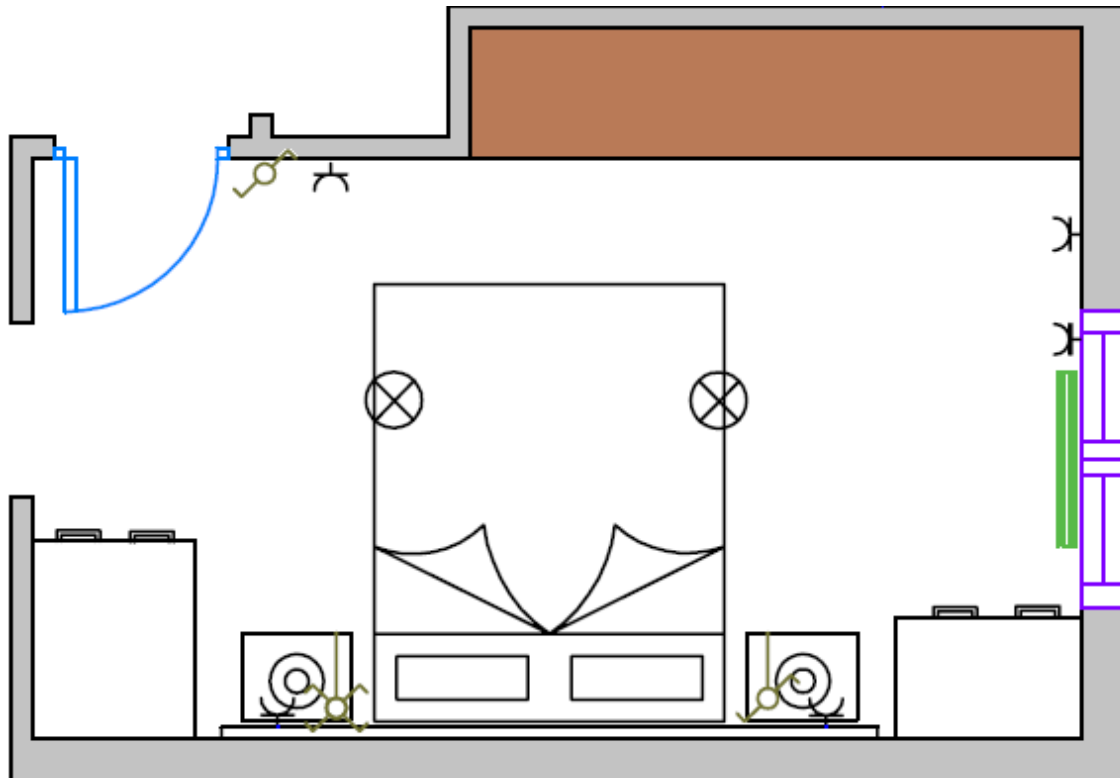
Plano de planta del dormitorio 1. Fuente: Elaboración propia
